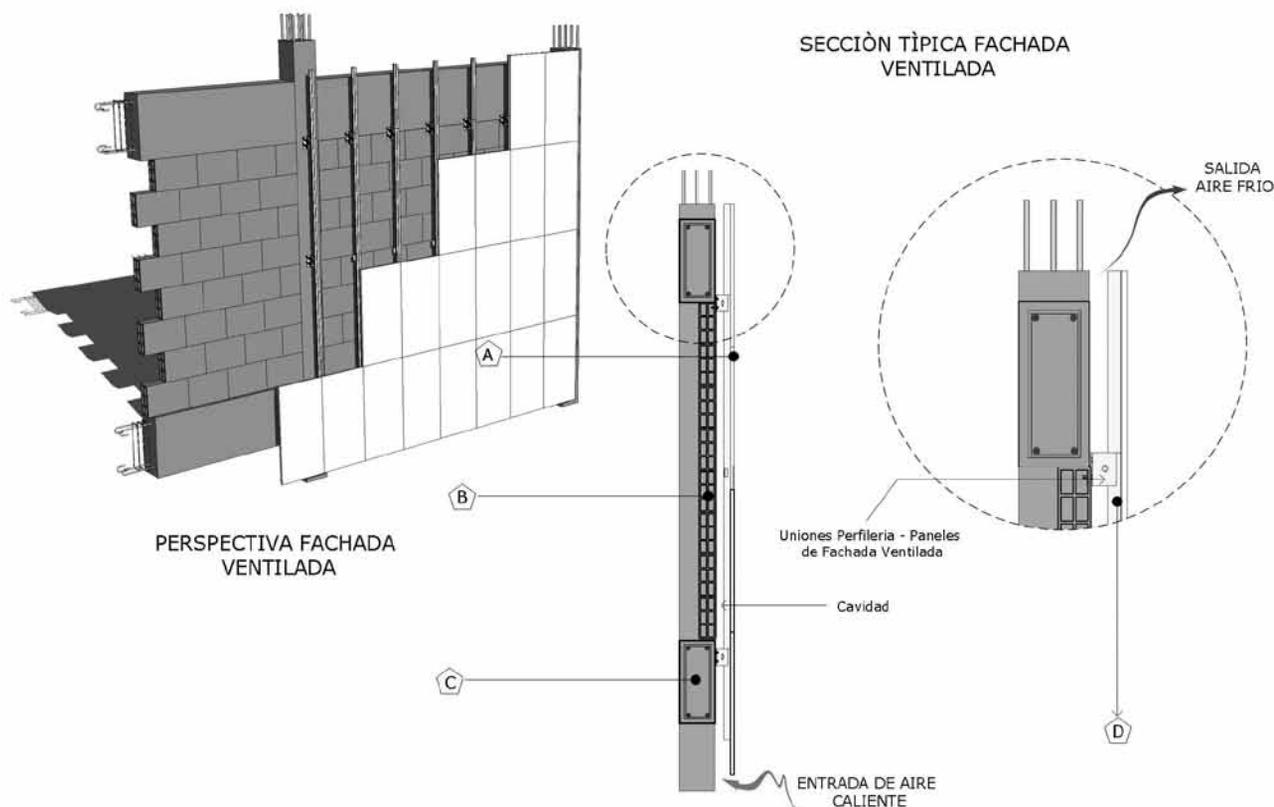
Sección típica y perspectiva fachada ventilada. A) Piel exterior. B) Piel interior. C) Estructura edificación. D) Subestructura-perfiles en aluminio. Fuente: elaboración propia.
